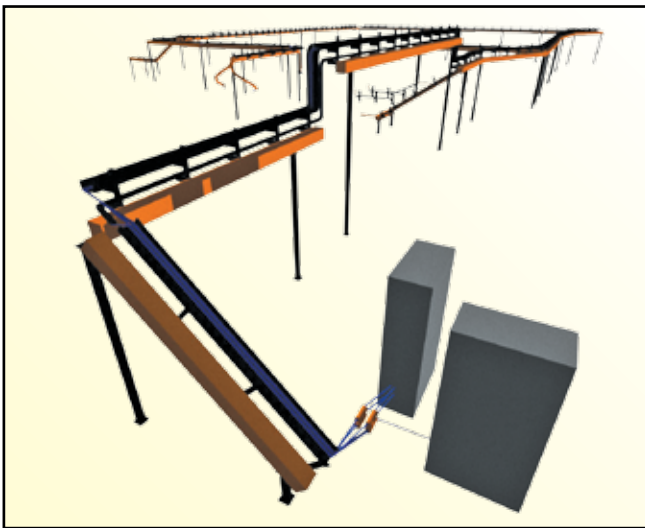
Модель кабельных конструкций, выполненная в ПК Model Studio CS Кабельное хозяйство
